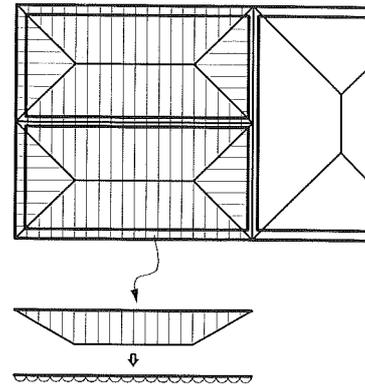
べた布基礎の底盤接地圧の基礎ばり負担分を求めるための亀甲分割
